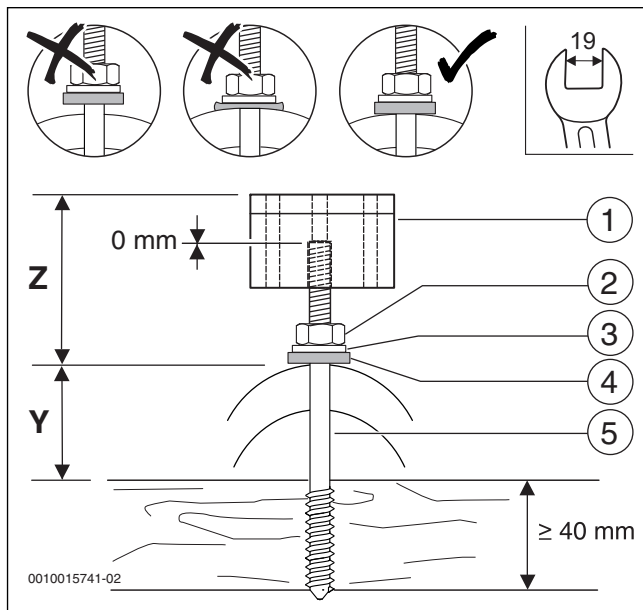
Tornillo de doble rosca montado con caballete de soporte
